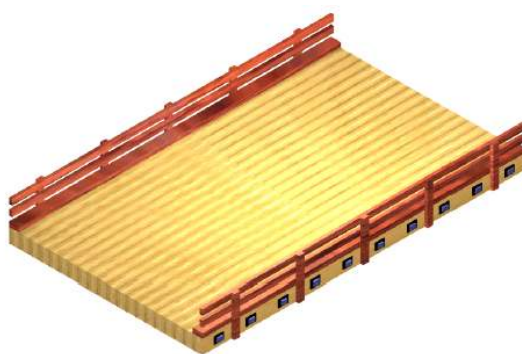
Detalhe de seção de ponte utilizando madeira laminada protendida
